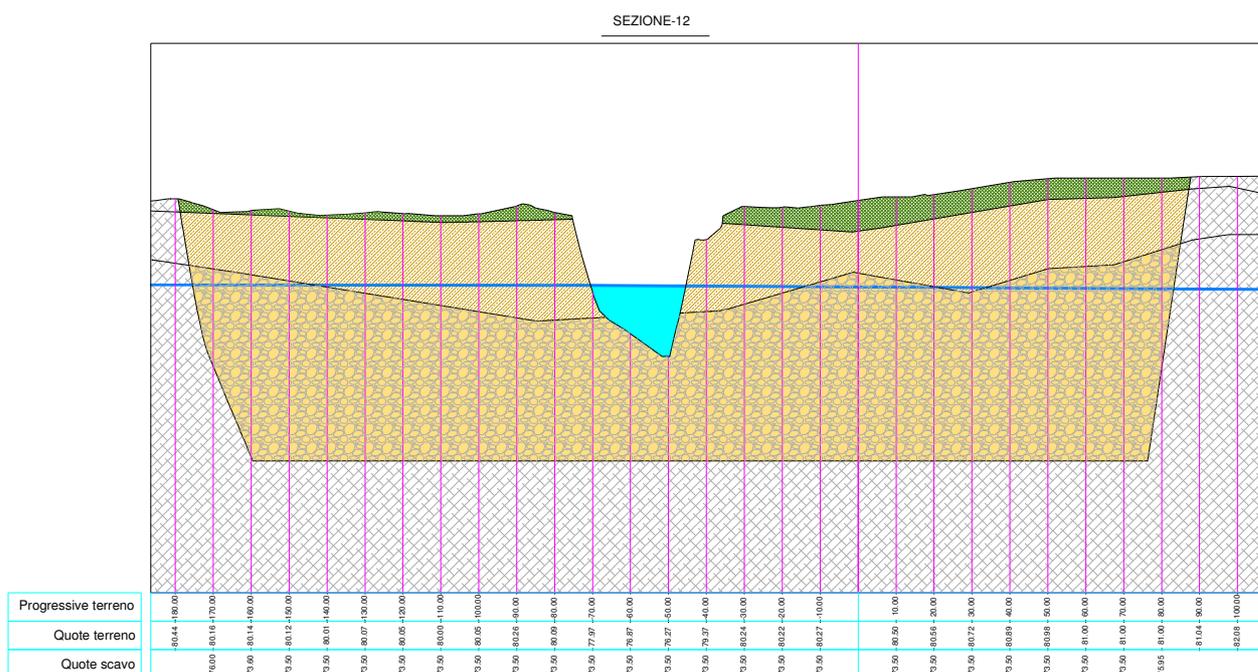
SEZIONE TIPO SCAVO DA CAVA DI PRESTITO
